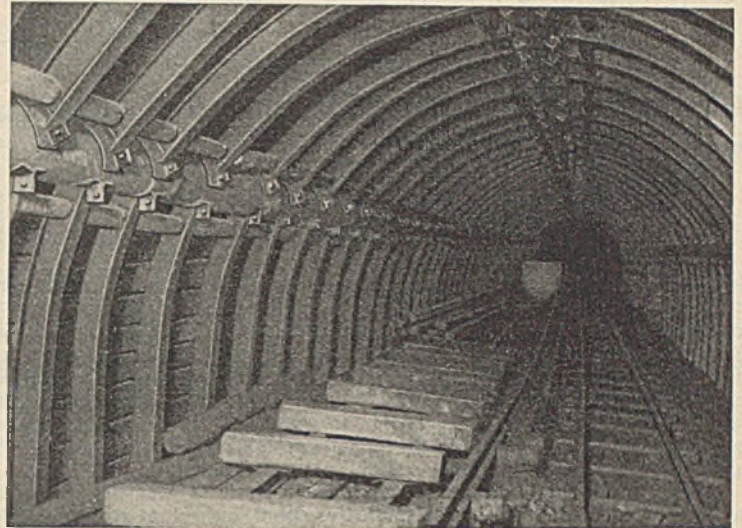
Rundausbau mit Kniebeschuh nach Moll.
